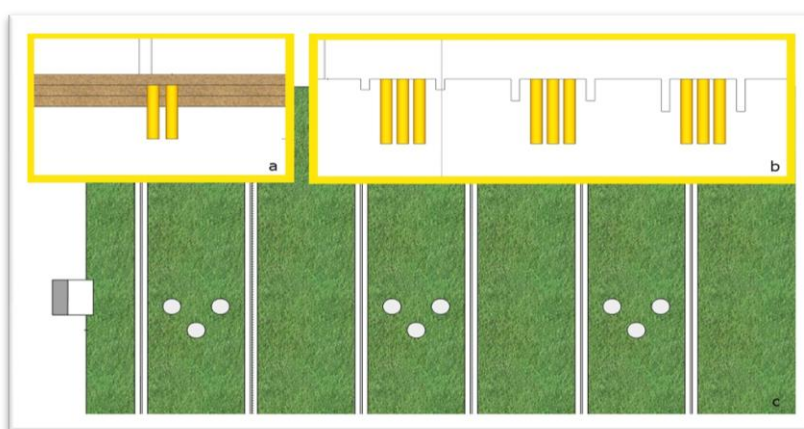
Vista da Instalação das Sondas no terreno em: a) corte transversal; b) corte longitudinal; c) planta
